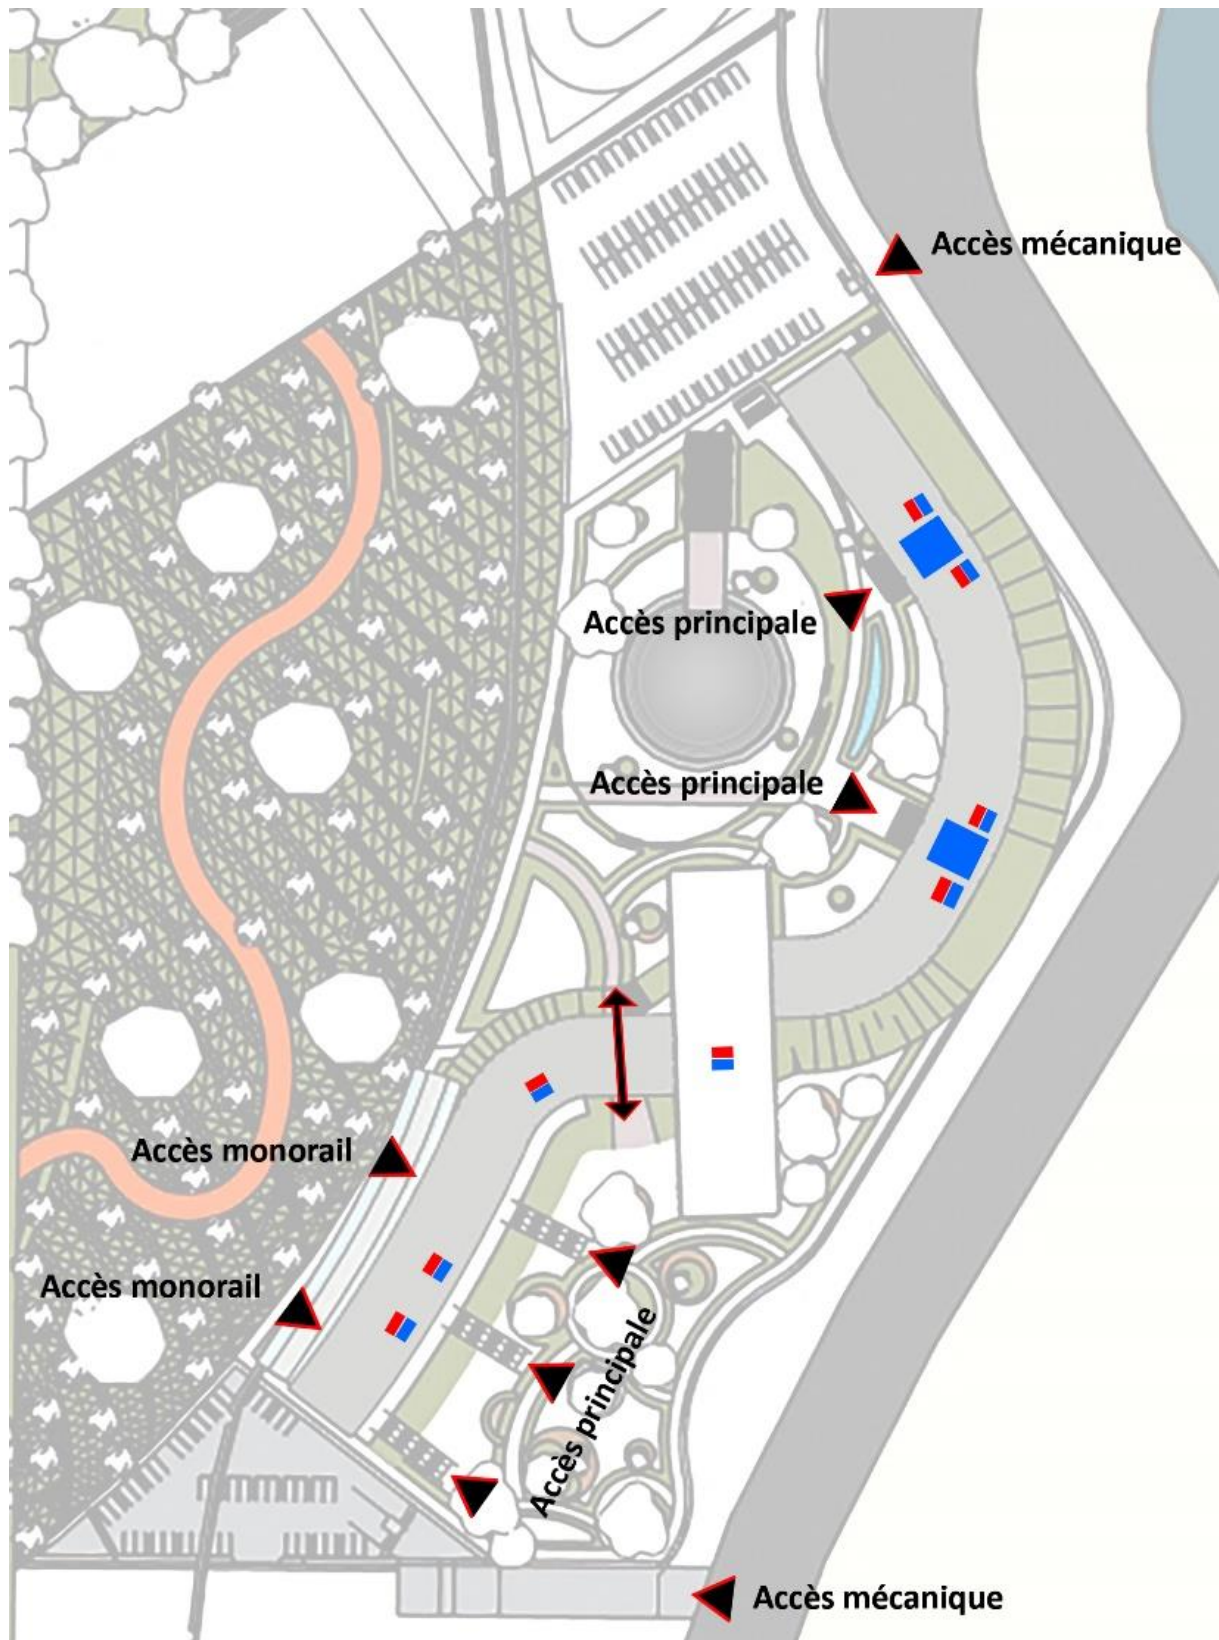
schéma des accès sur plan de masse et la position des escaliers
